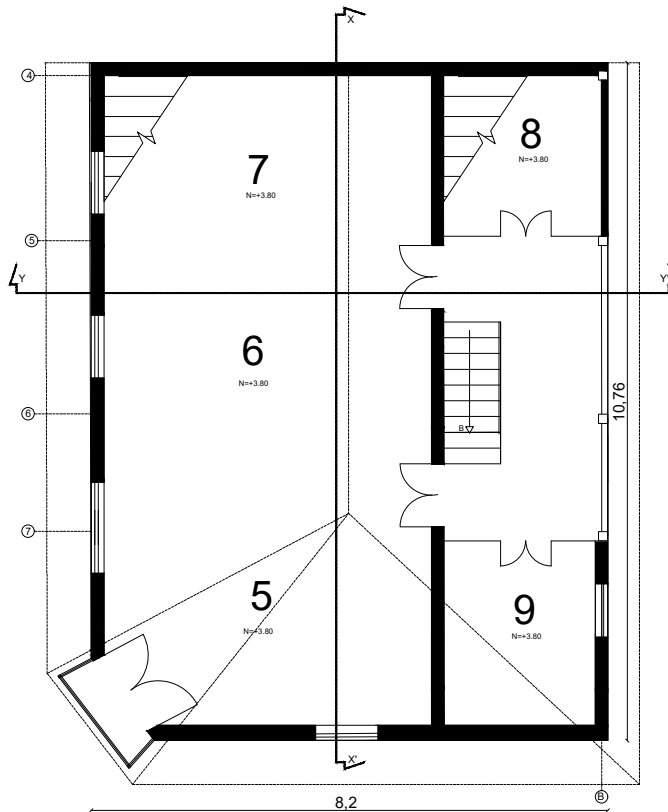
Planta Arquitectónica - Vivienda 001. Esc: 1:1500
